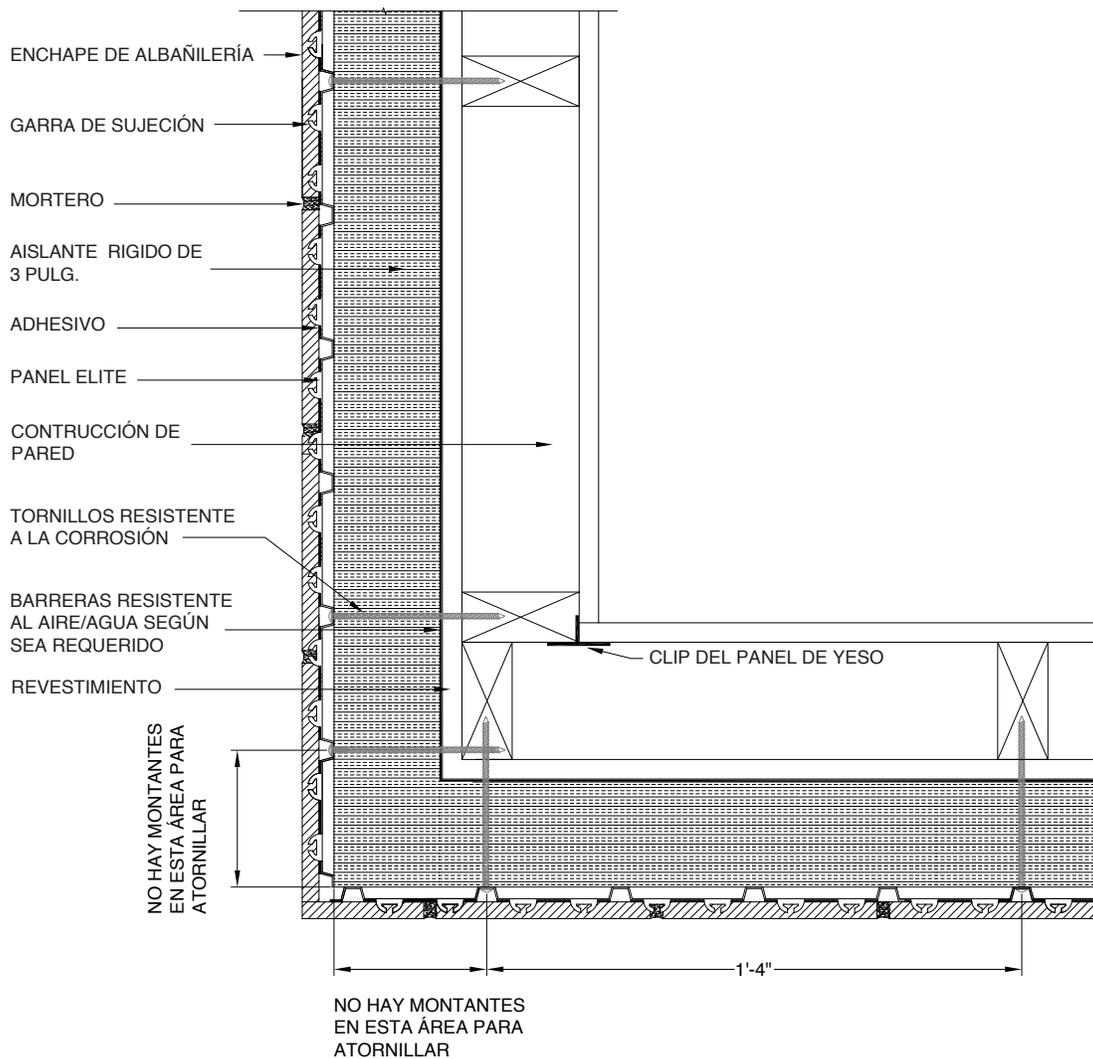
VISTA SUPERIOR CON ESQUINA CON 2 MONTANTES
